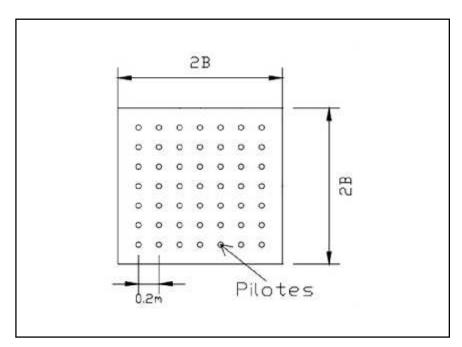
Vista en planta de la distribución de pilotes en zona de influencia de la zapata.
